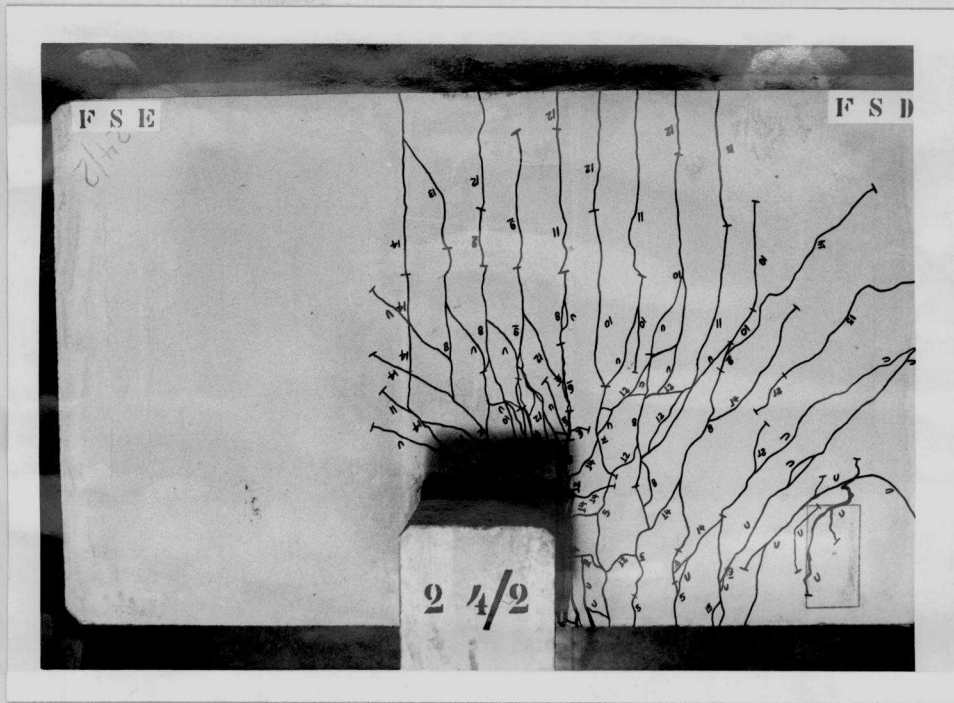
a - Fissuração na face superior do modelo EdL 24/2.
